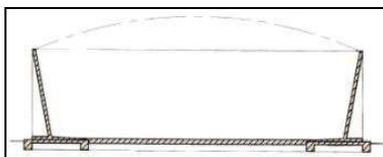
Sezione trasversale di un silo orizzontale: in evidenza la leggera pendenza delle pareti laterali
